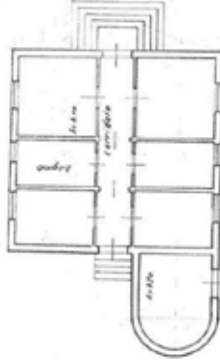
Fabbricato Part. 16. Planimetria Piano Terra
